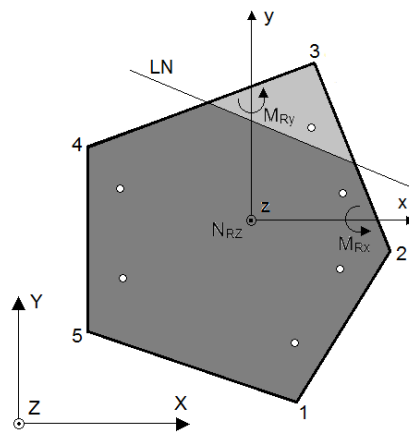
Definição do sistema de coordenadas e seção transversal
